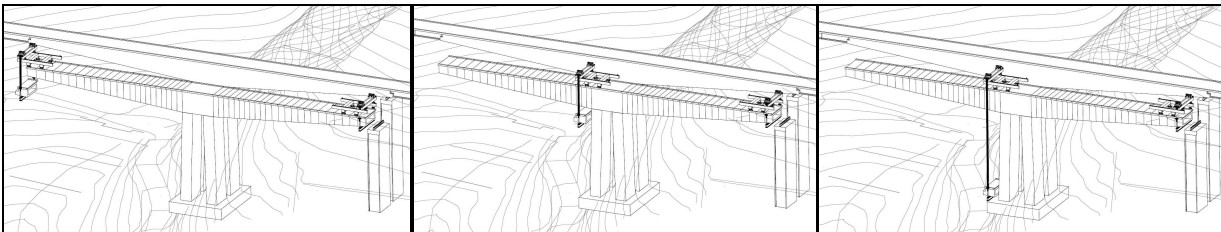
schema rimozione e movimentazione concio tipo travi gerber
